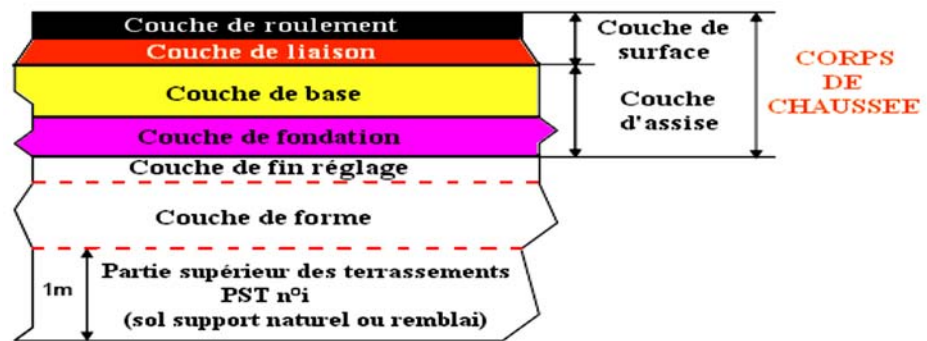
Schéma Théorique De La Structure Du Corps De Chaussée
